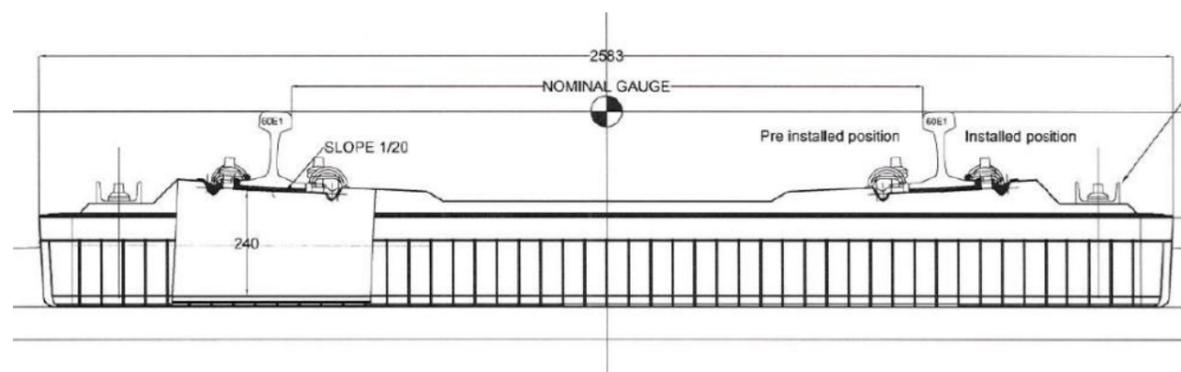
Exemple traverse HAS avec chausson (équipée d'attaches prémontées et de rail UIC60)
